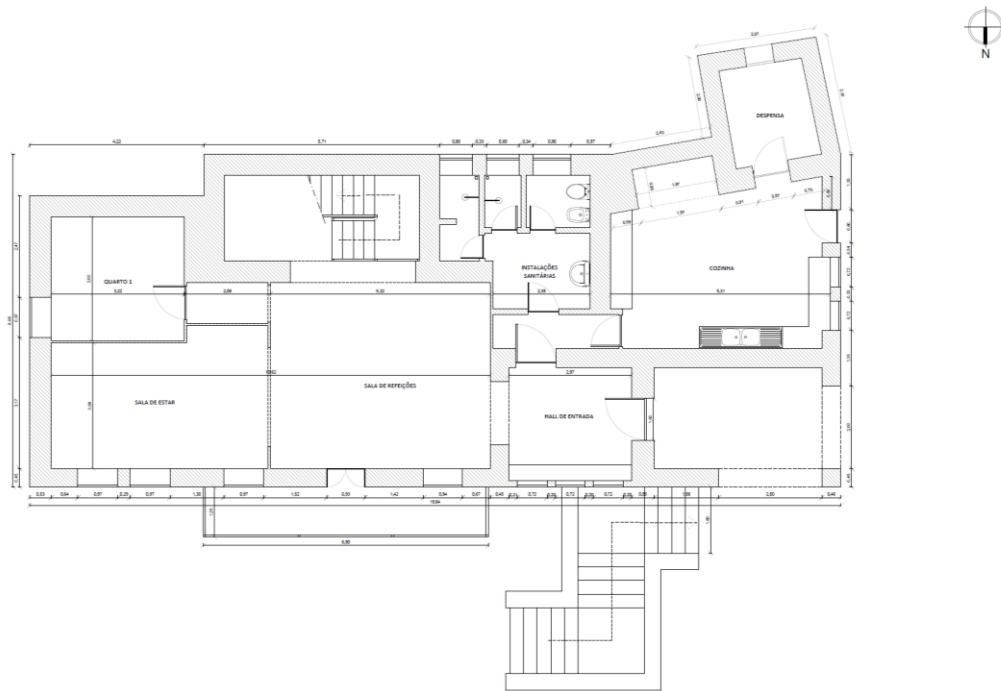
Planta de Levantamento Piso 0, Casa das Queimadas.
